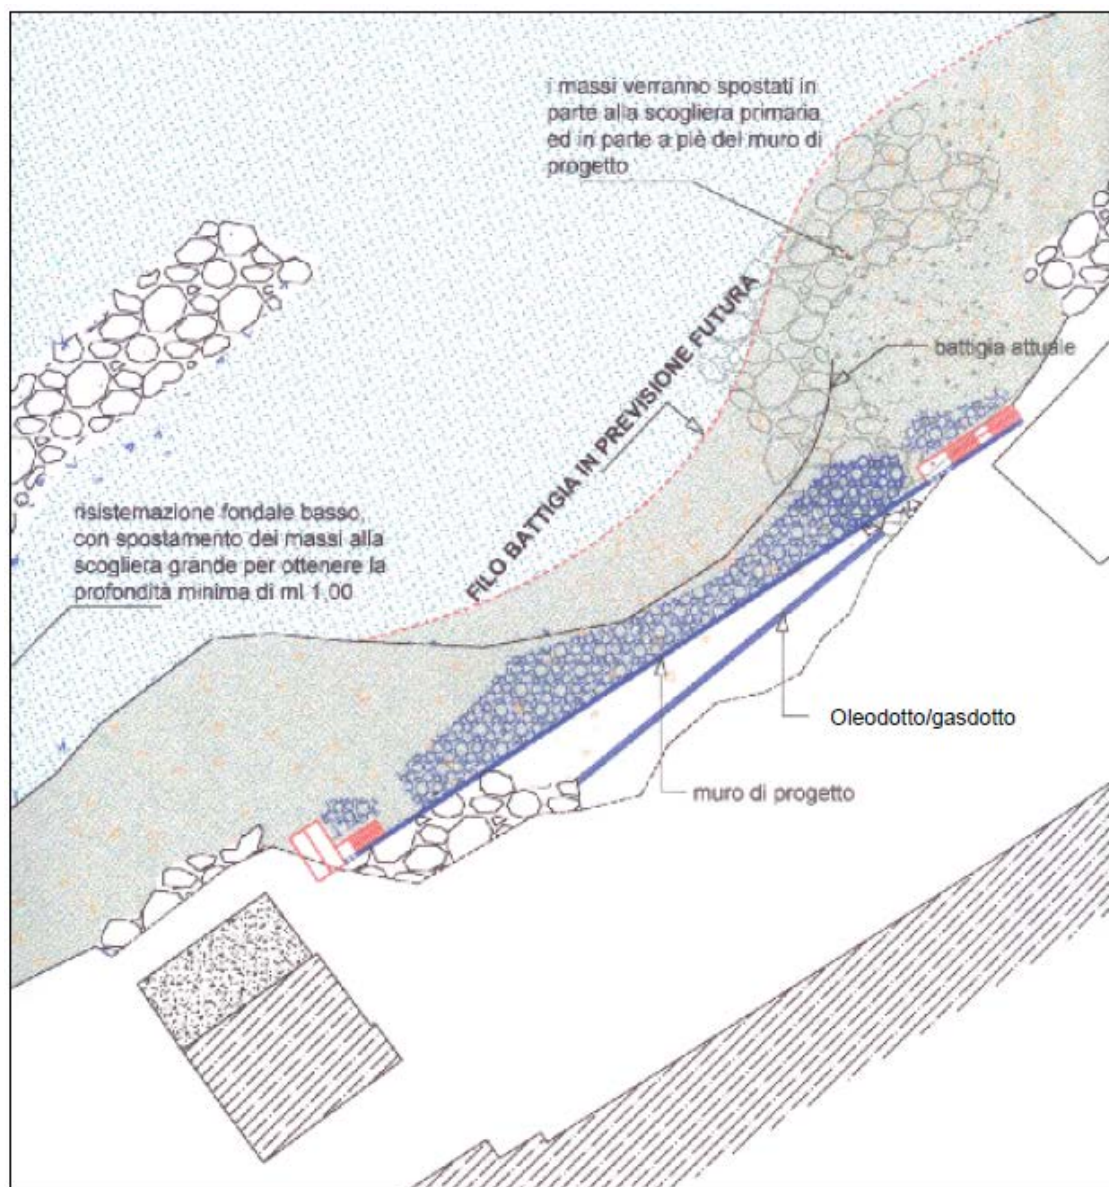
Stralcio della previsione di progetto- I° intervento -2001
